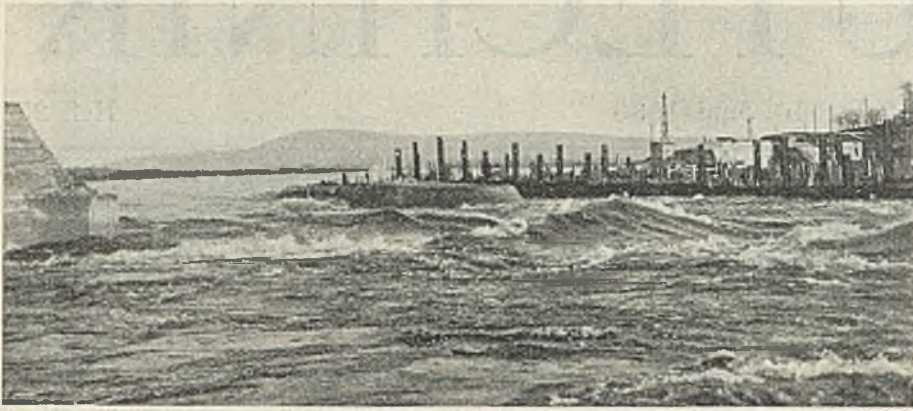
I. Wehrabschnitt bei Hochwasser.
